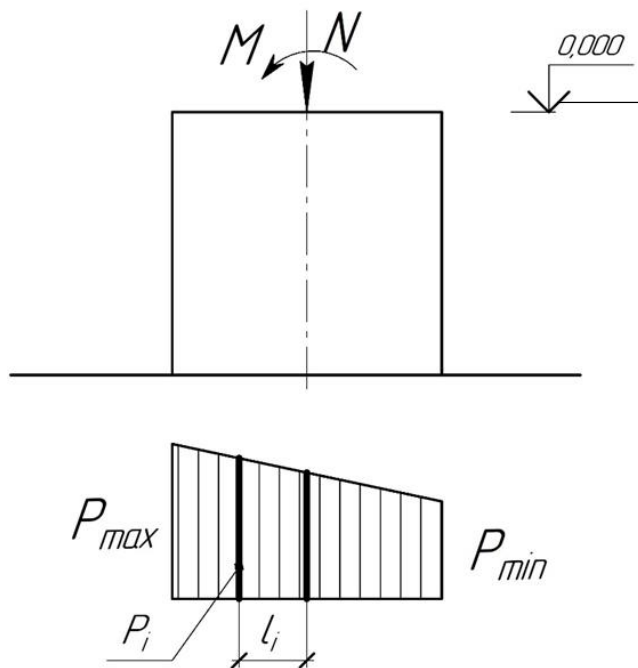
Розрахункова схема позациентрово навантаженого фундаменту
